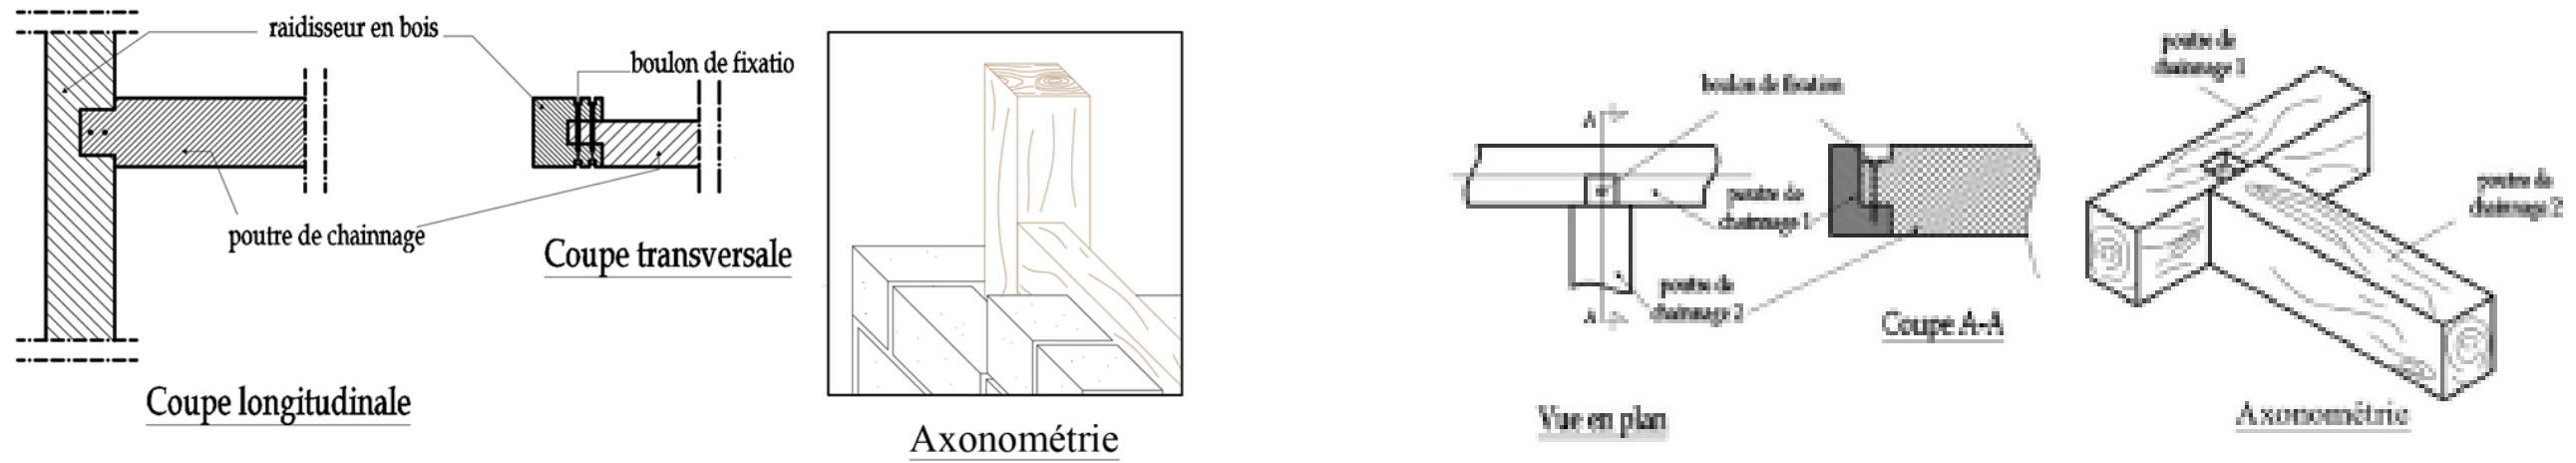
Assemblage de deux poutre de chainage pour le plancher
